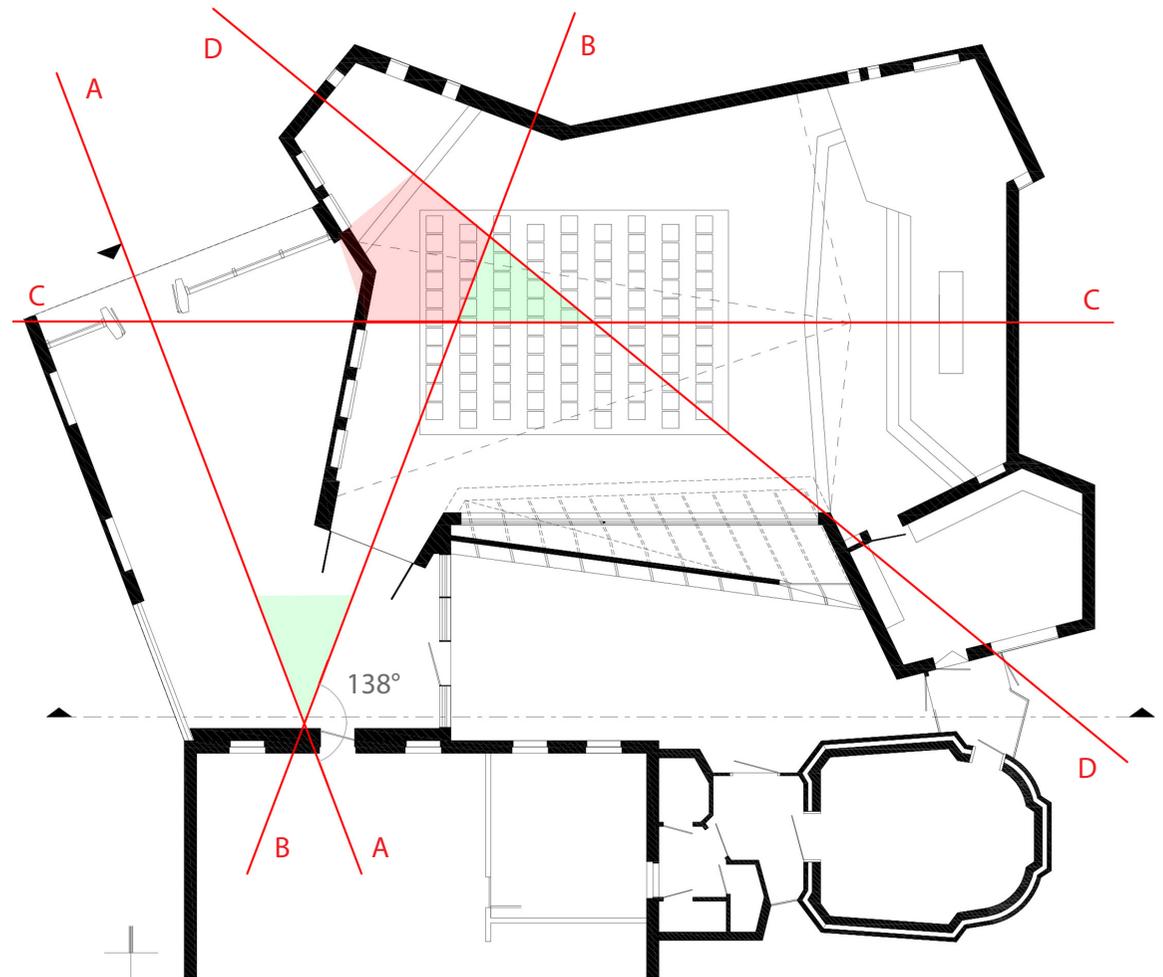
Grundriss mit Hauptachsen (o.M.)
